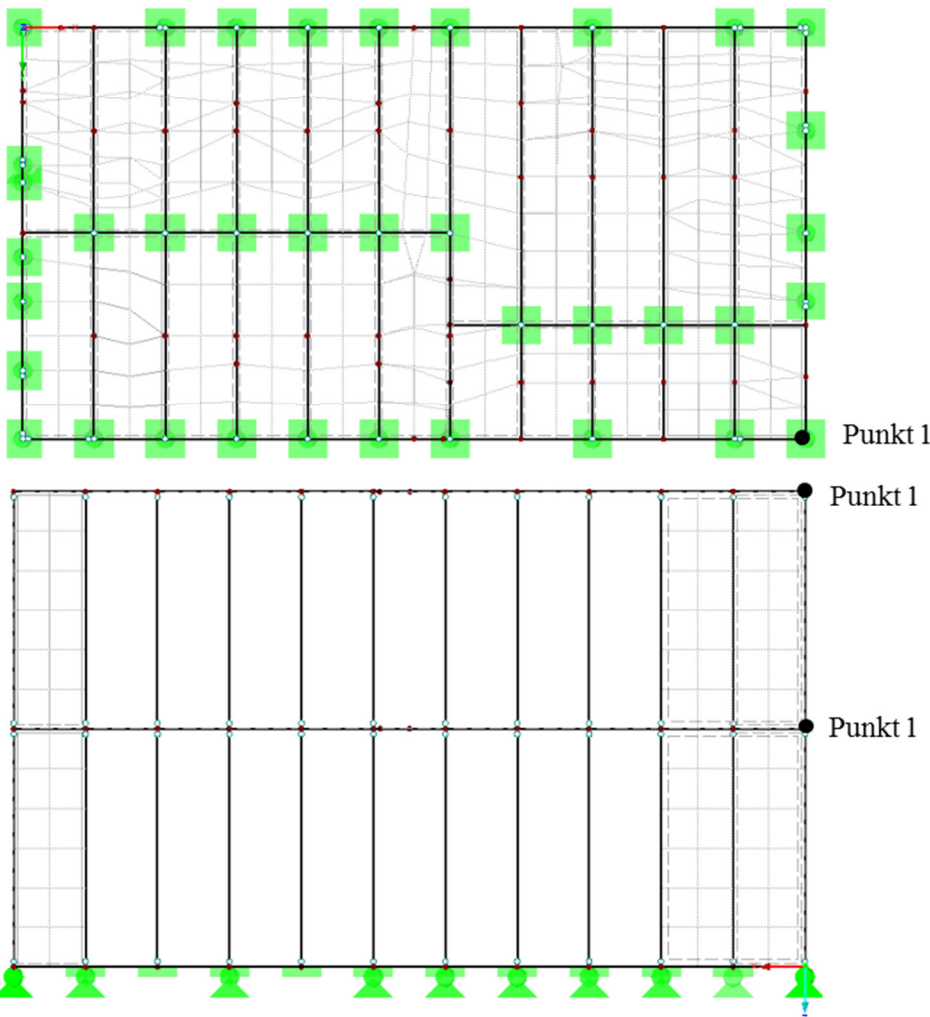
Grundriss und Aufriss mit den Punkten 1 und 2
